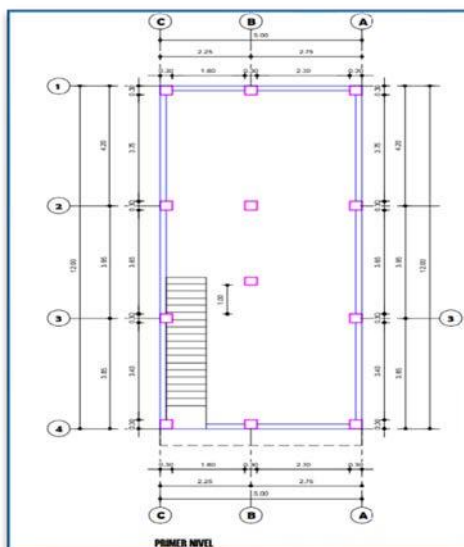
Esquema en planta vivienda autoconstruida 2
